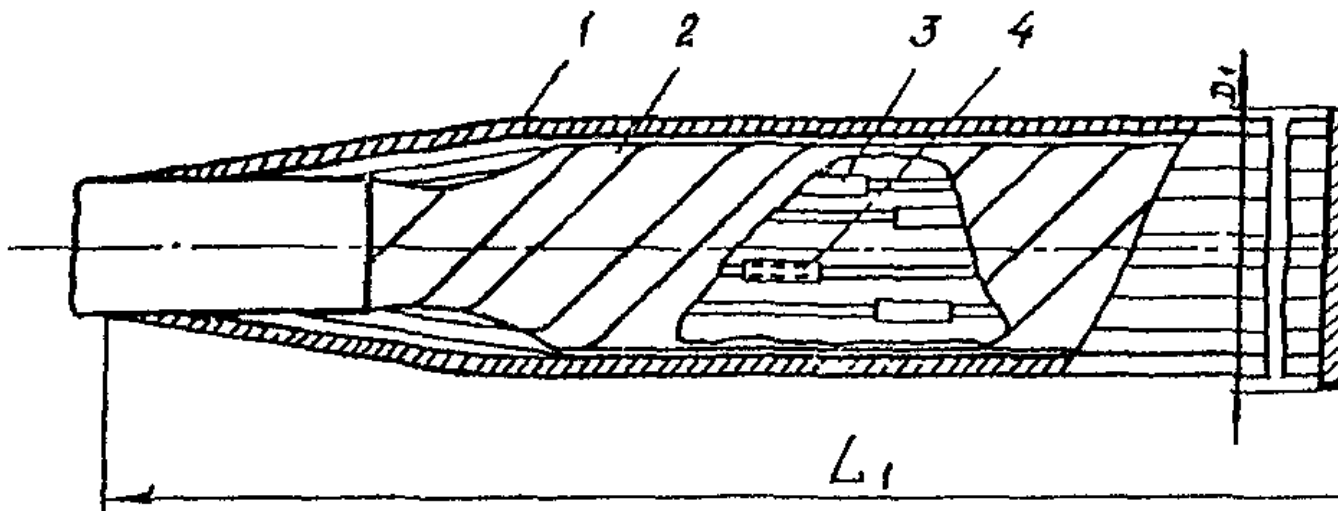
Поливинилхлоридная соединительная муфта для контрольных кабелей с поливинилхлоридными оболочками: 1 - корпус муфты; 2 - соединение жил; 3 - поливинилхлоридная гильза; 4 - подмотка из липкой поливинилхлоридной ленты; 5 - место сварки полумуфт между собой
